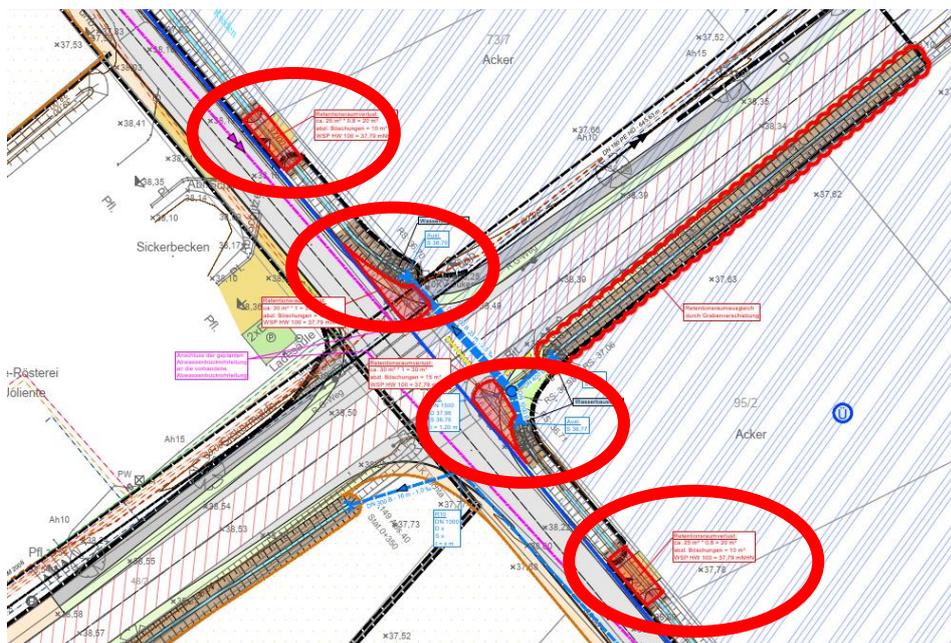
Lageplanausschnitt - Hochwassereingriffsflächen
